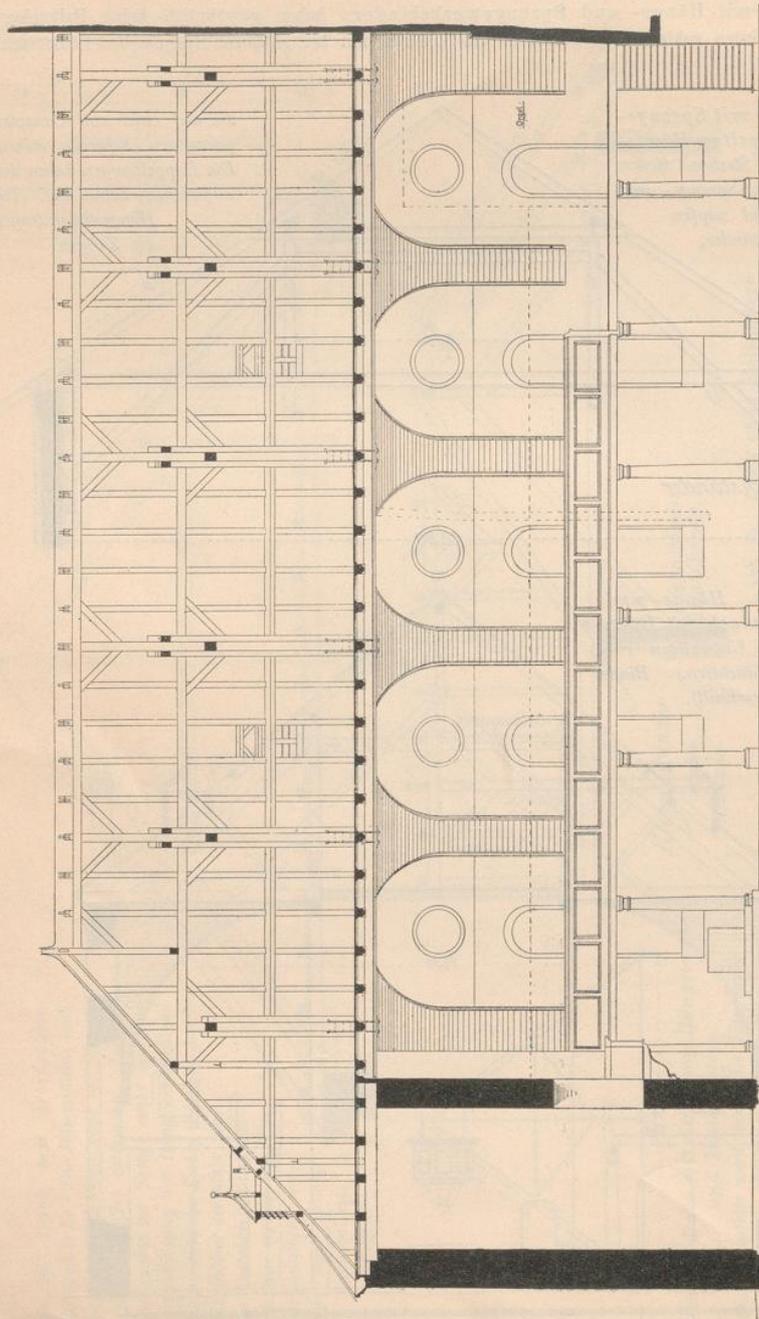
Dach. Hänge- und Sprengwerksdach mit Balkenlage. (Kirche in Schlichtern.) Längenschnitt.
